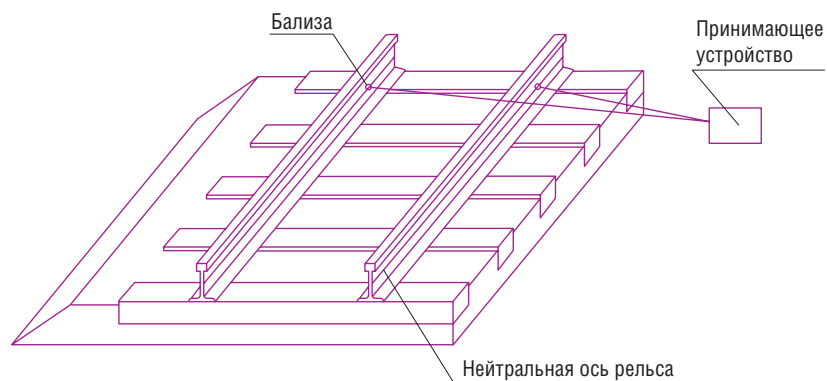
Схема расположения бализы и передачи сигнала на приемное устройство
